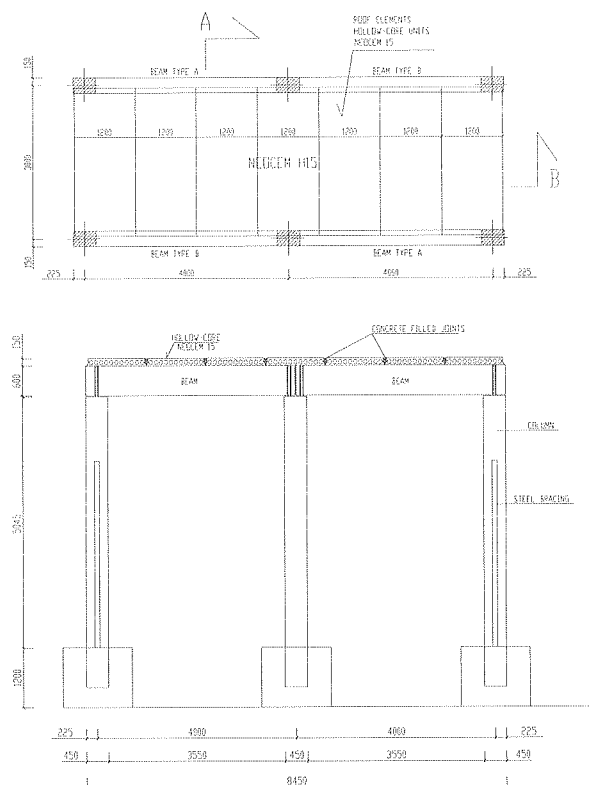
pianta della copertura e prospetto del prototipo prefabbricato
